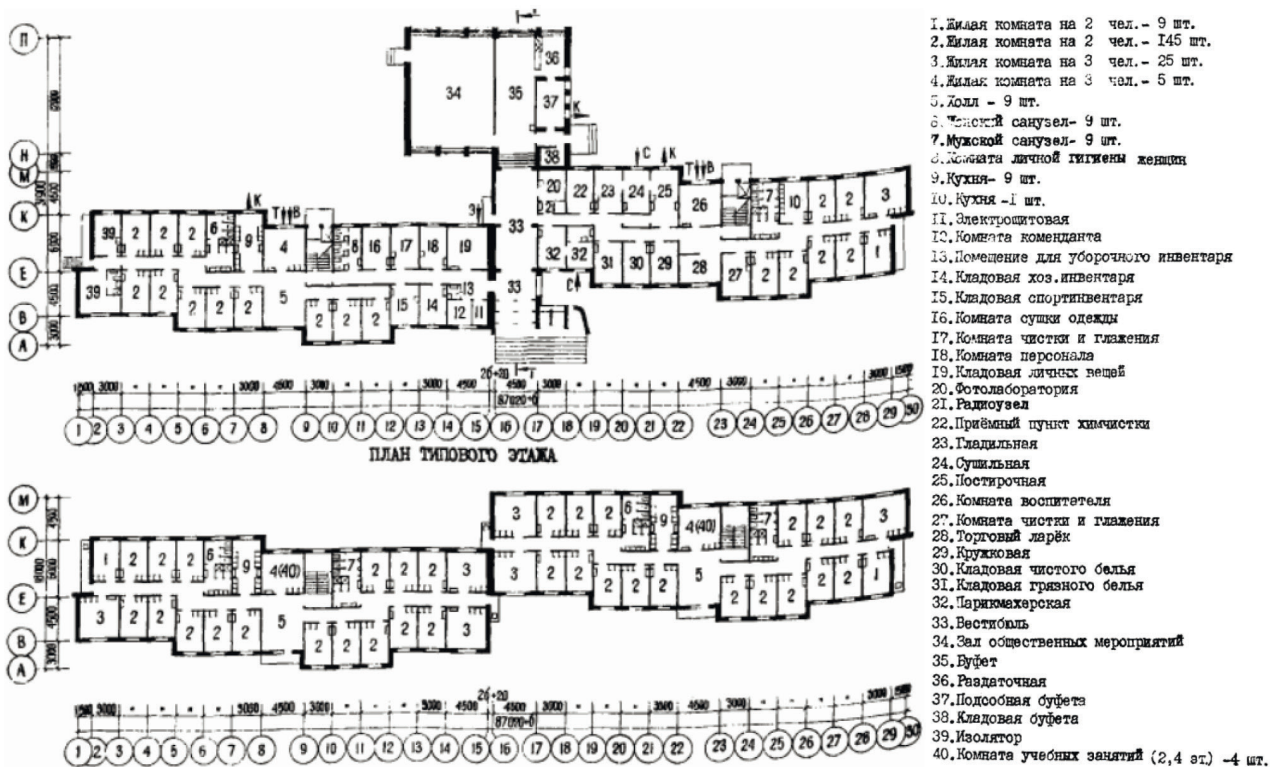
Plan du rez-de-chaussée et plan d'étage types avec liste des pièces
